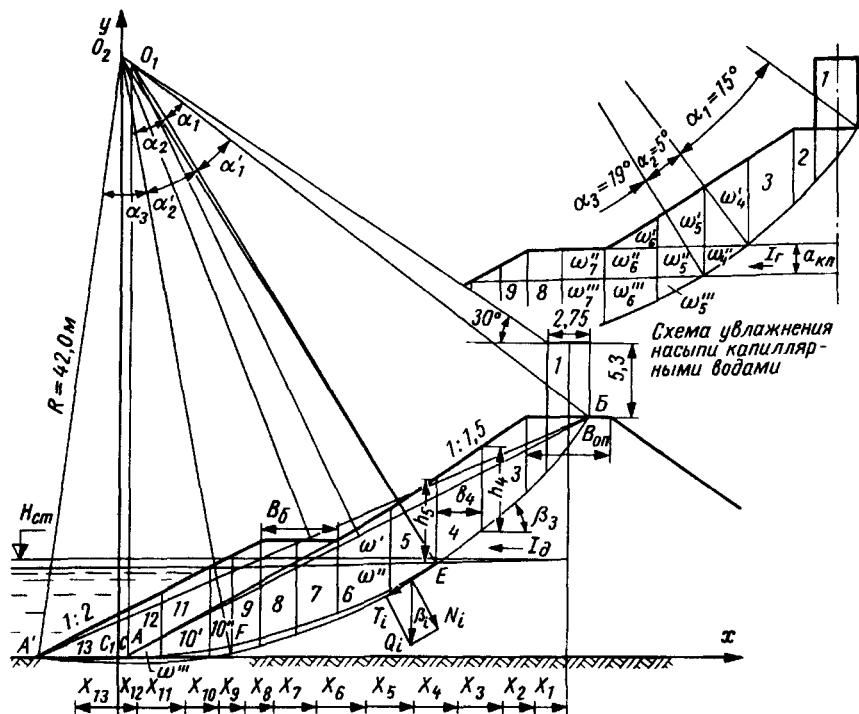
Расчетная схема для определения K_{yc} пойменной насыпи
